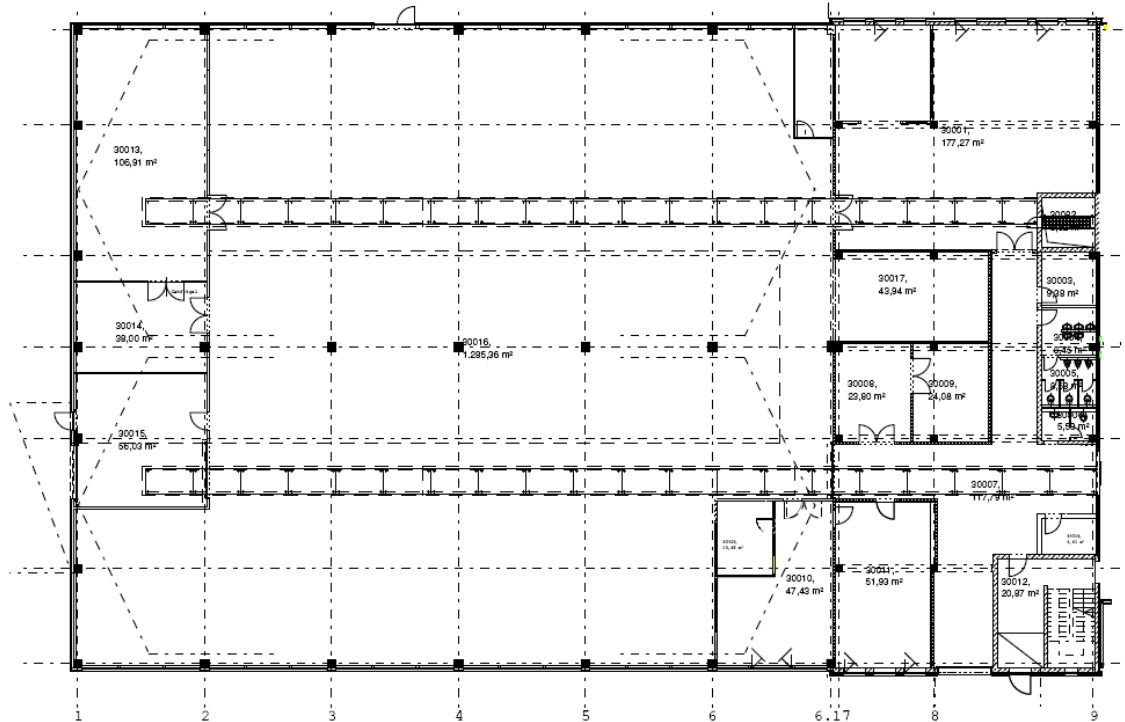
Grundriss B_30, Bauabschnitt 1 Erdgeschoß
